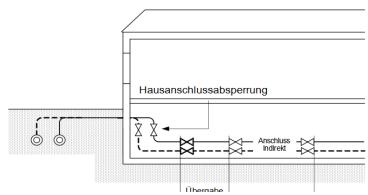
Hausanschlussleitung und Hausstation nach AGFW FE 515
